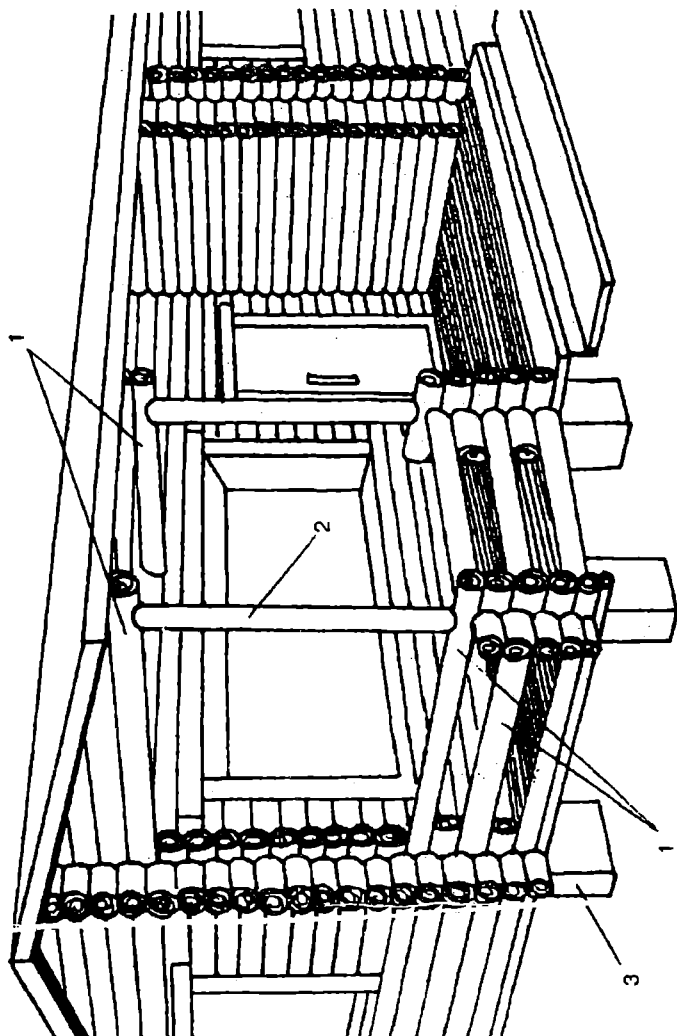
Архитектурное решение, где удлиненные бревна стен формируют каркас веранды:
